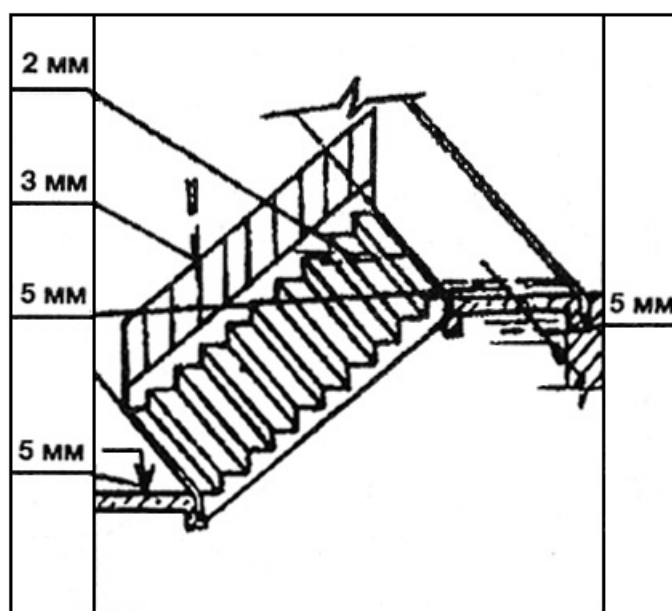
Допустимые отклонения при монтаже лестничных маршей и площадок
